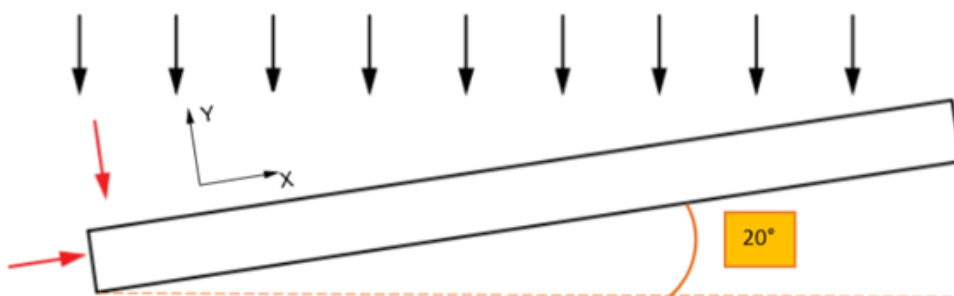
Chargement de la Poutre inclinée de l'auditorium
